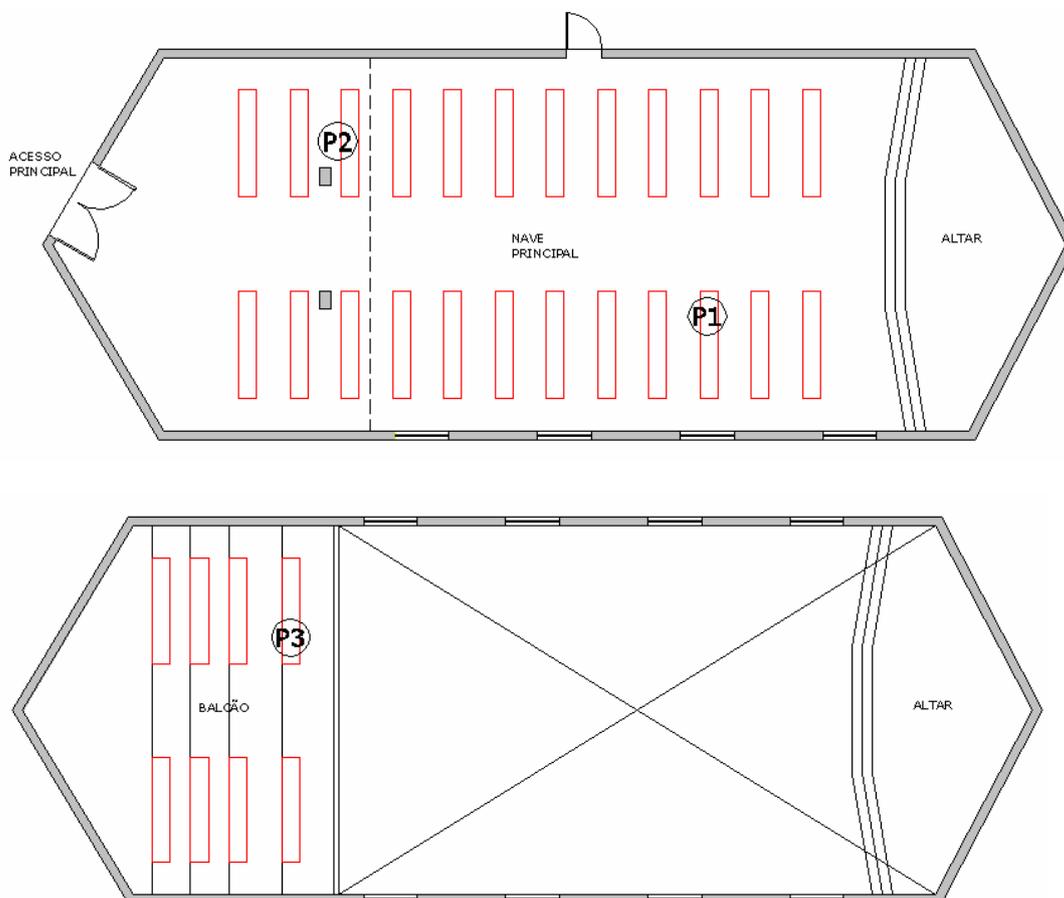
Planta da Igreja com localização dos pontos de medição (P1, P2, P3)
